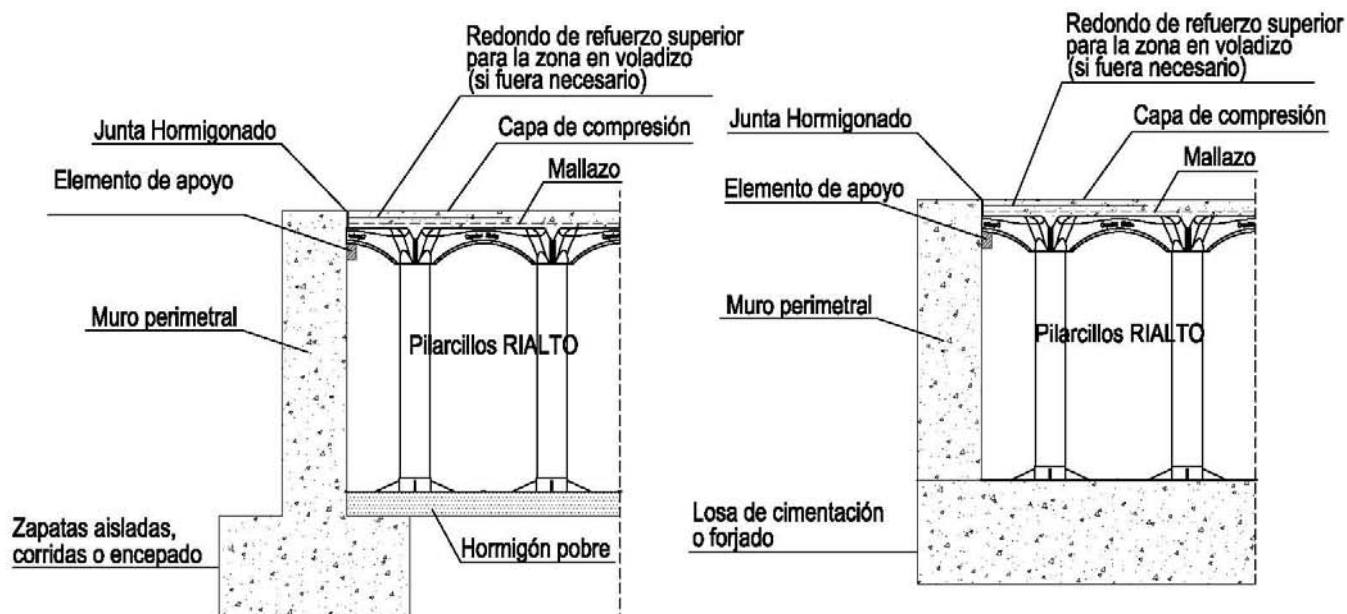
RECRECIDO HORIZONTAL DE CANTO ELEVADO CON "CÚPOLEX RIALTO" SOBRE SUPERFICIE INCLINADA
